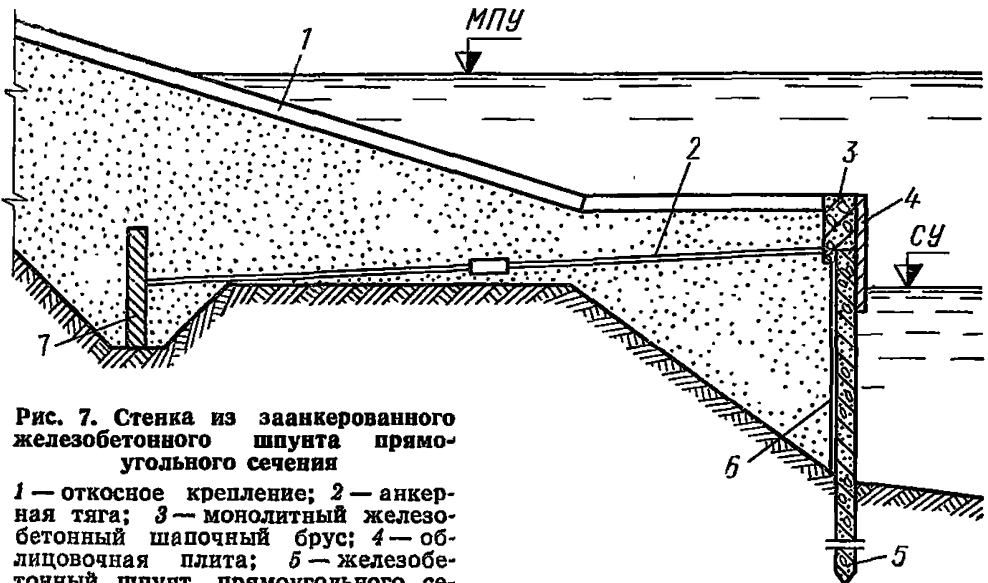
Стенка из заанкеренного железобетонного шпунта прямоугольного сечения
